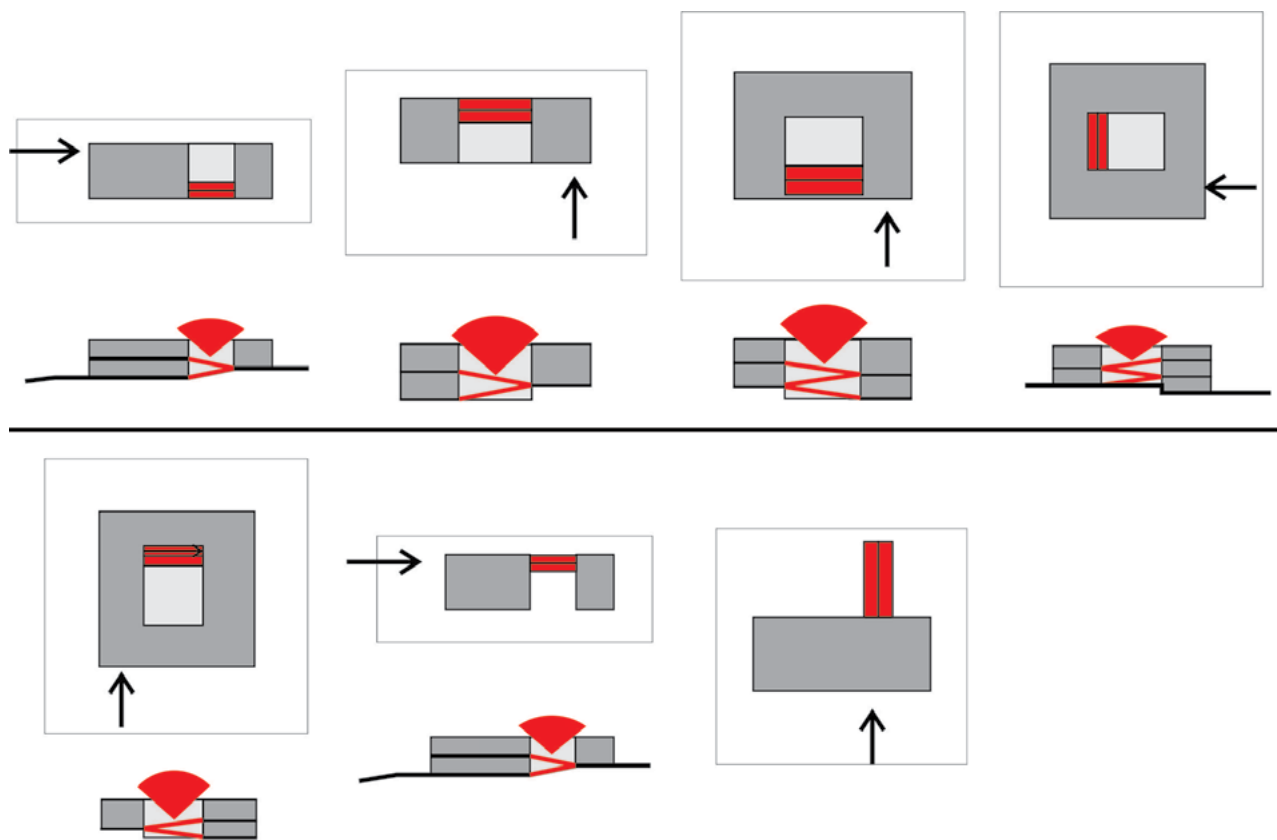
Diagramas que revelan los principales tipos de planos de vivienda con la ubicación de rampas y accesos.
